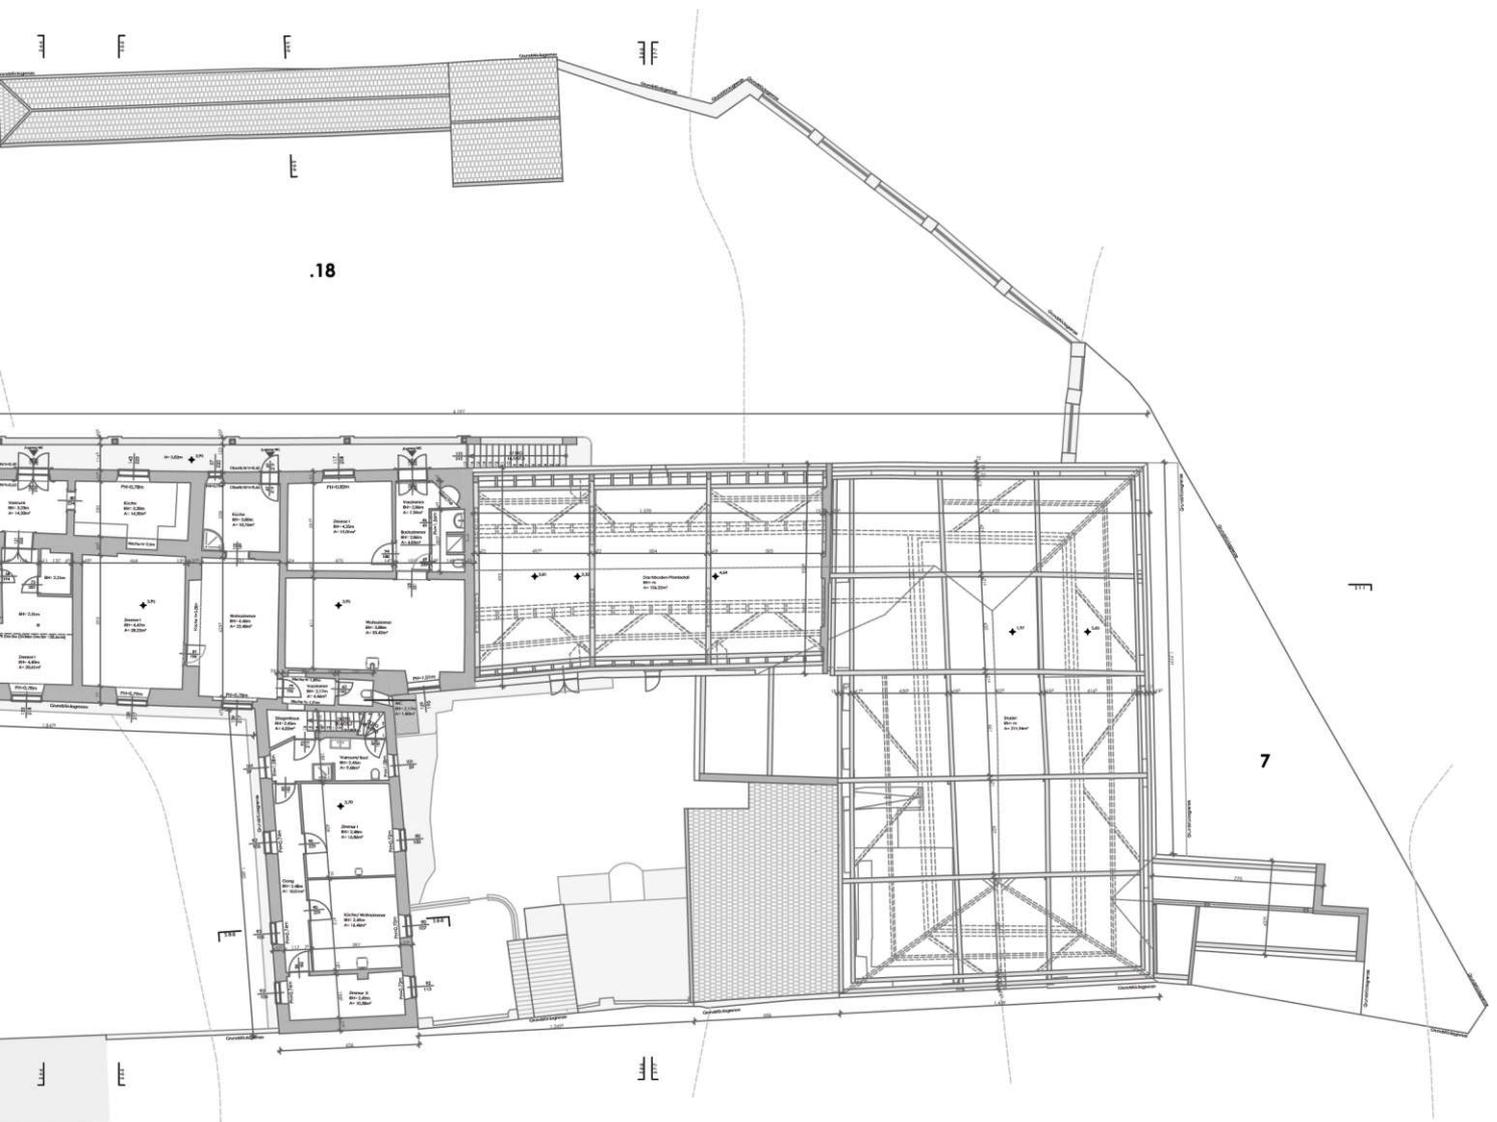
Bestandsplan Grundriss Erdgeschoss M 1:250
